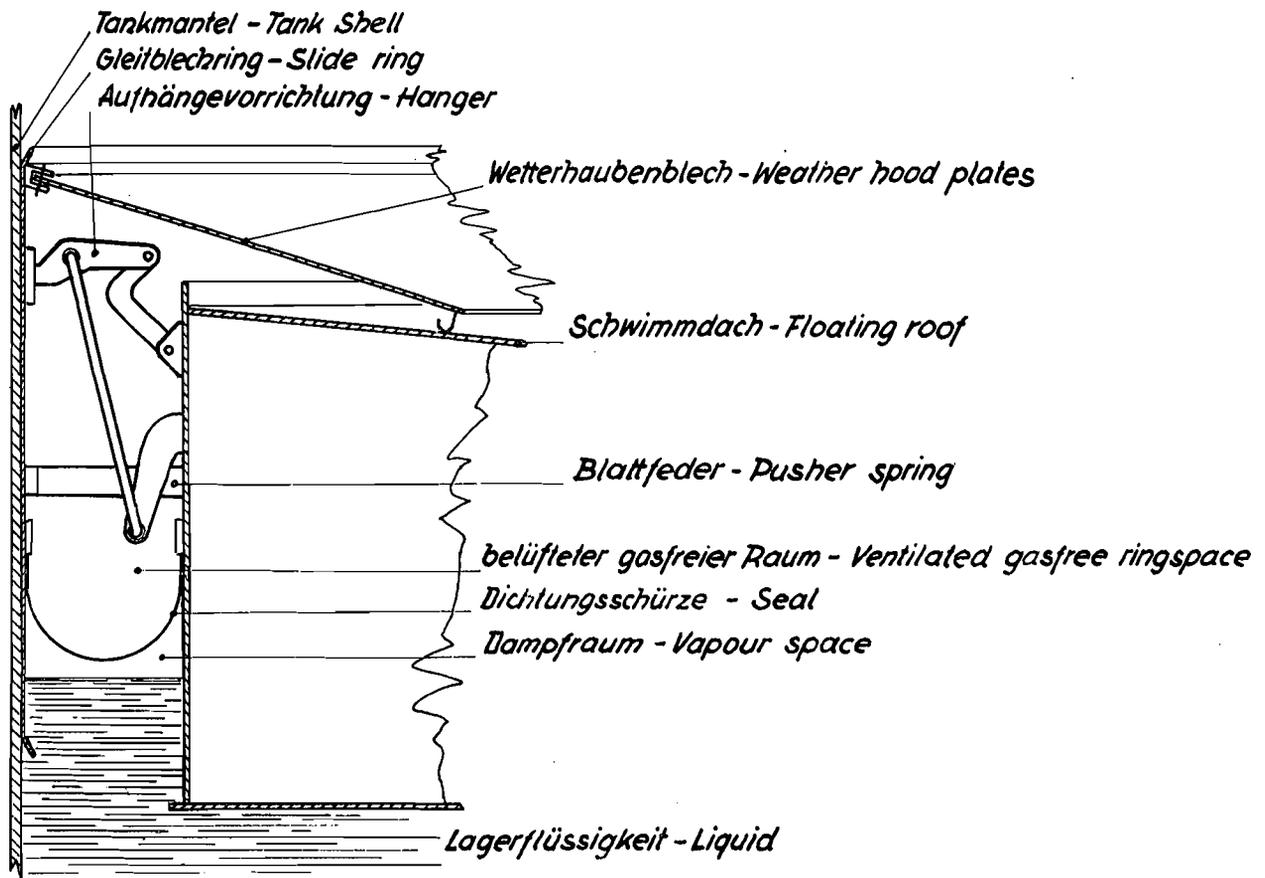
Schematischer Querschnitt durch eine Schwimmdachdichtung
